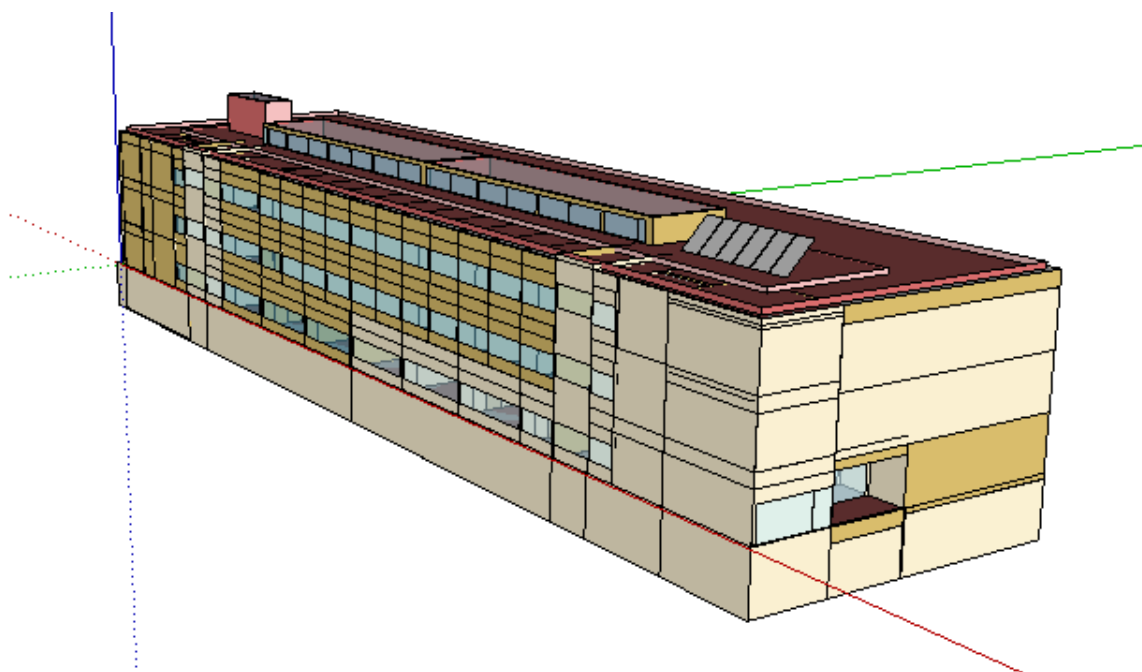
Vista (2) das fachadas Norte e Nascente do edifício
